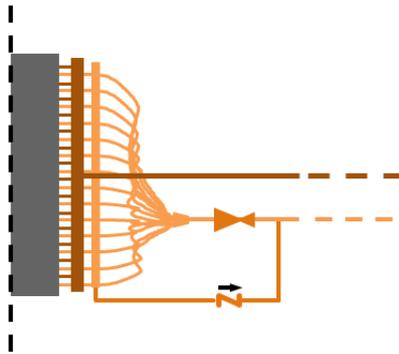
Anschlussplan Expansionsventil und Rückschlagventil
